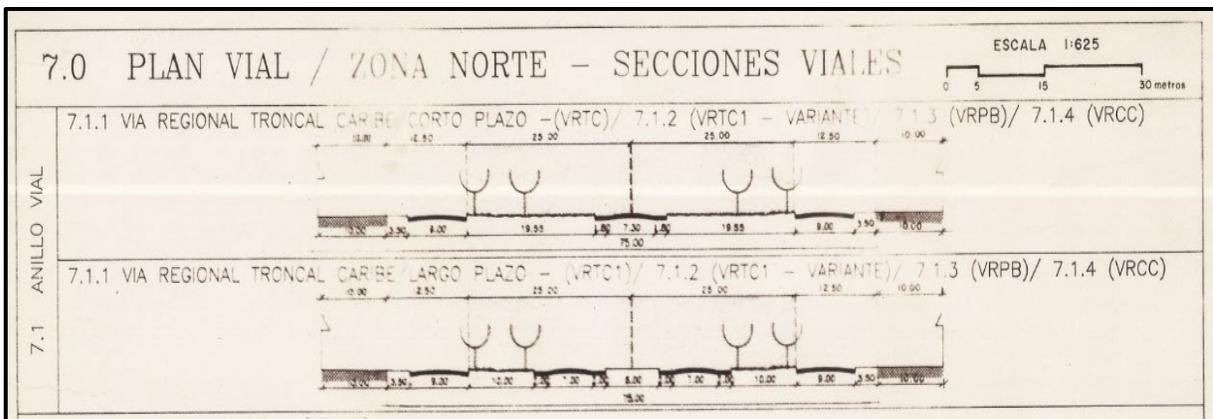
PLANO DE ESTRUCTURA VIAL. Plan Vial /Zona Norte - Secciones Viales. Vía 7.1.2 VR Variante.
